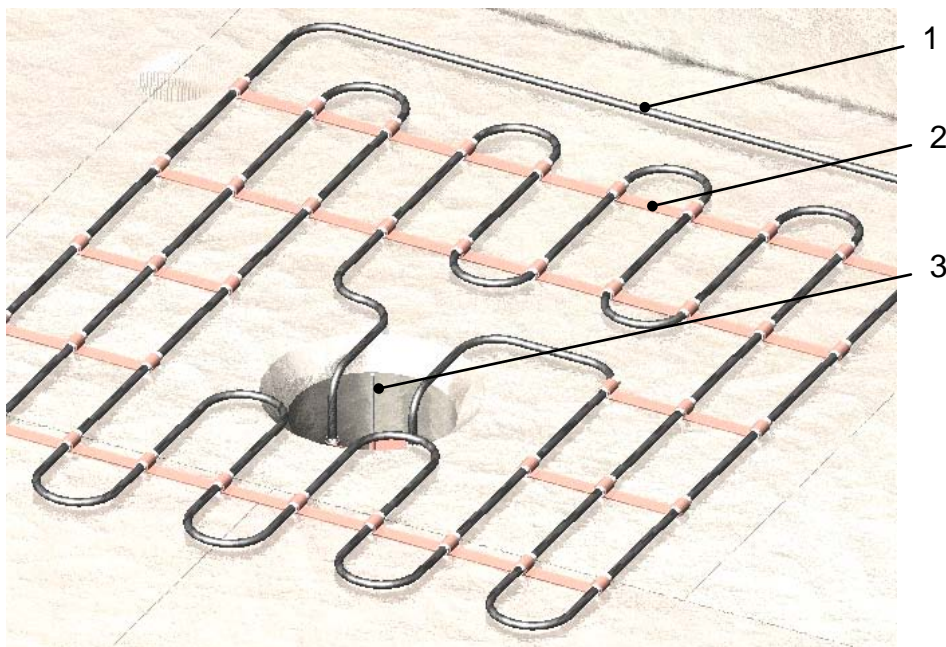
Установка нагревательного кабеля на плоской кровле вокруг воронки.
